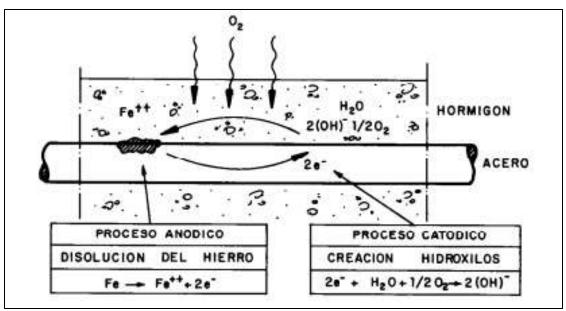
Pila electroquímica de corrosión en el hormigón armado
